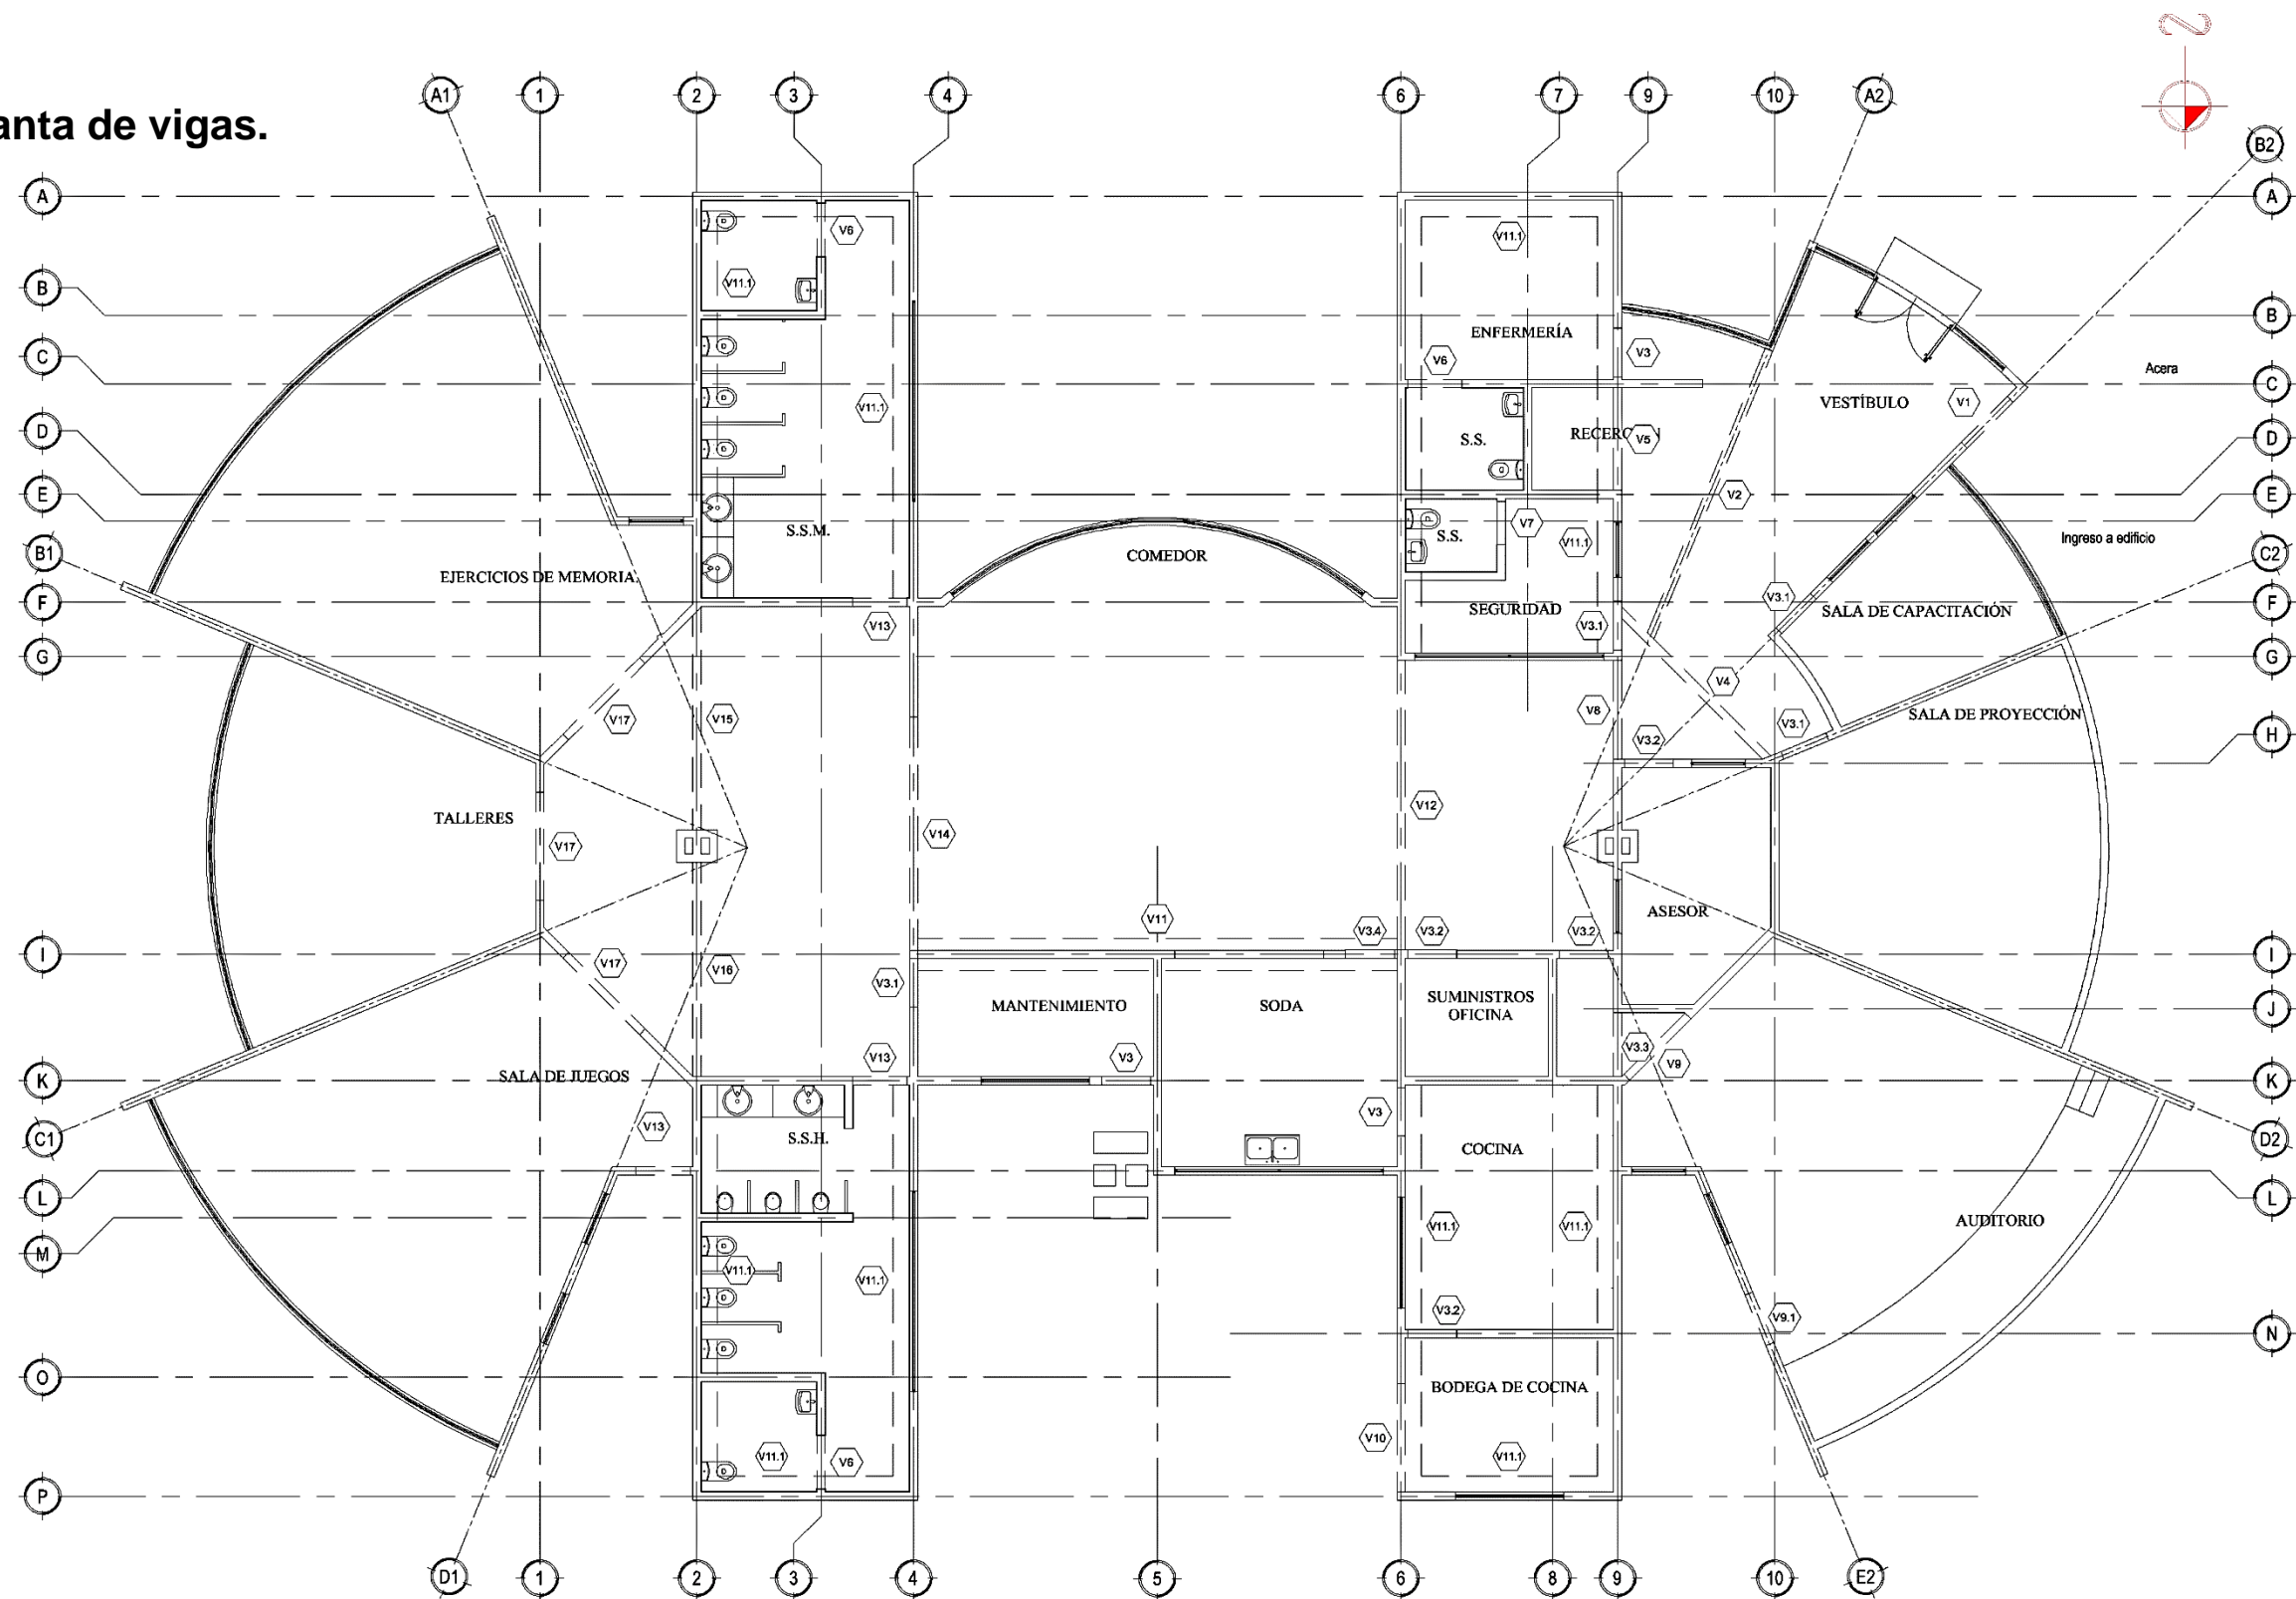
Planta de vigas. Fuente: elaboración propia.
